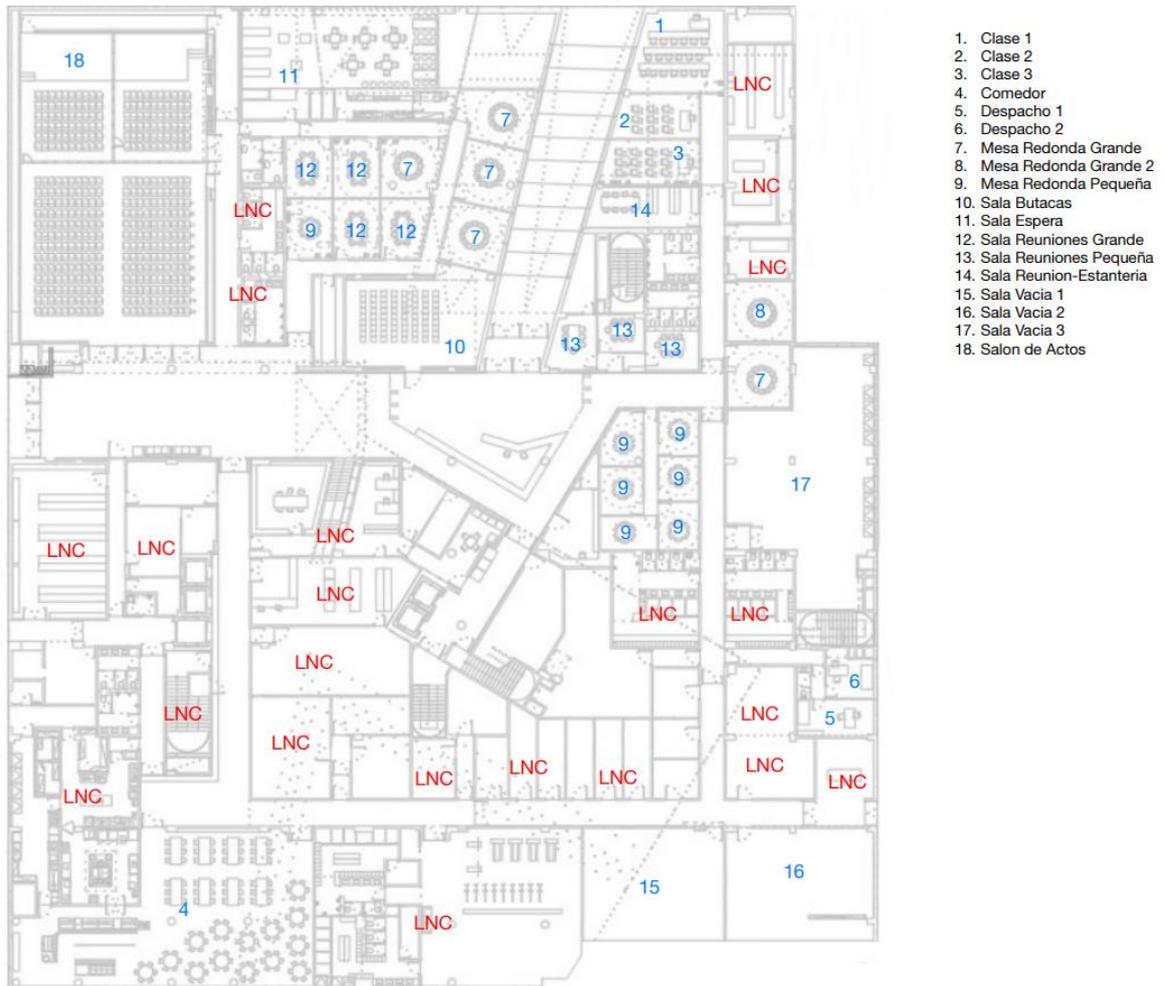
Plano Planta Baja con Enumeración de locales y leyenda
